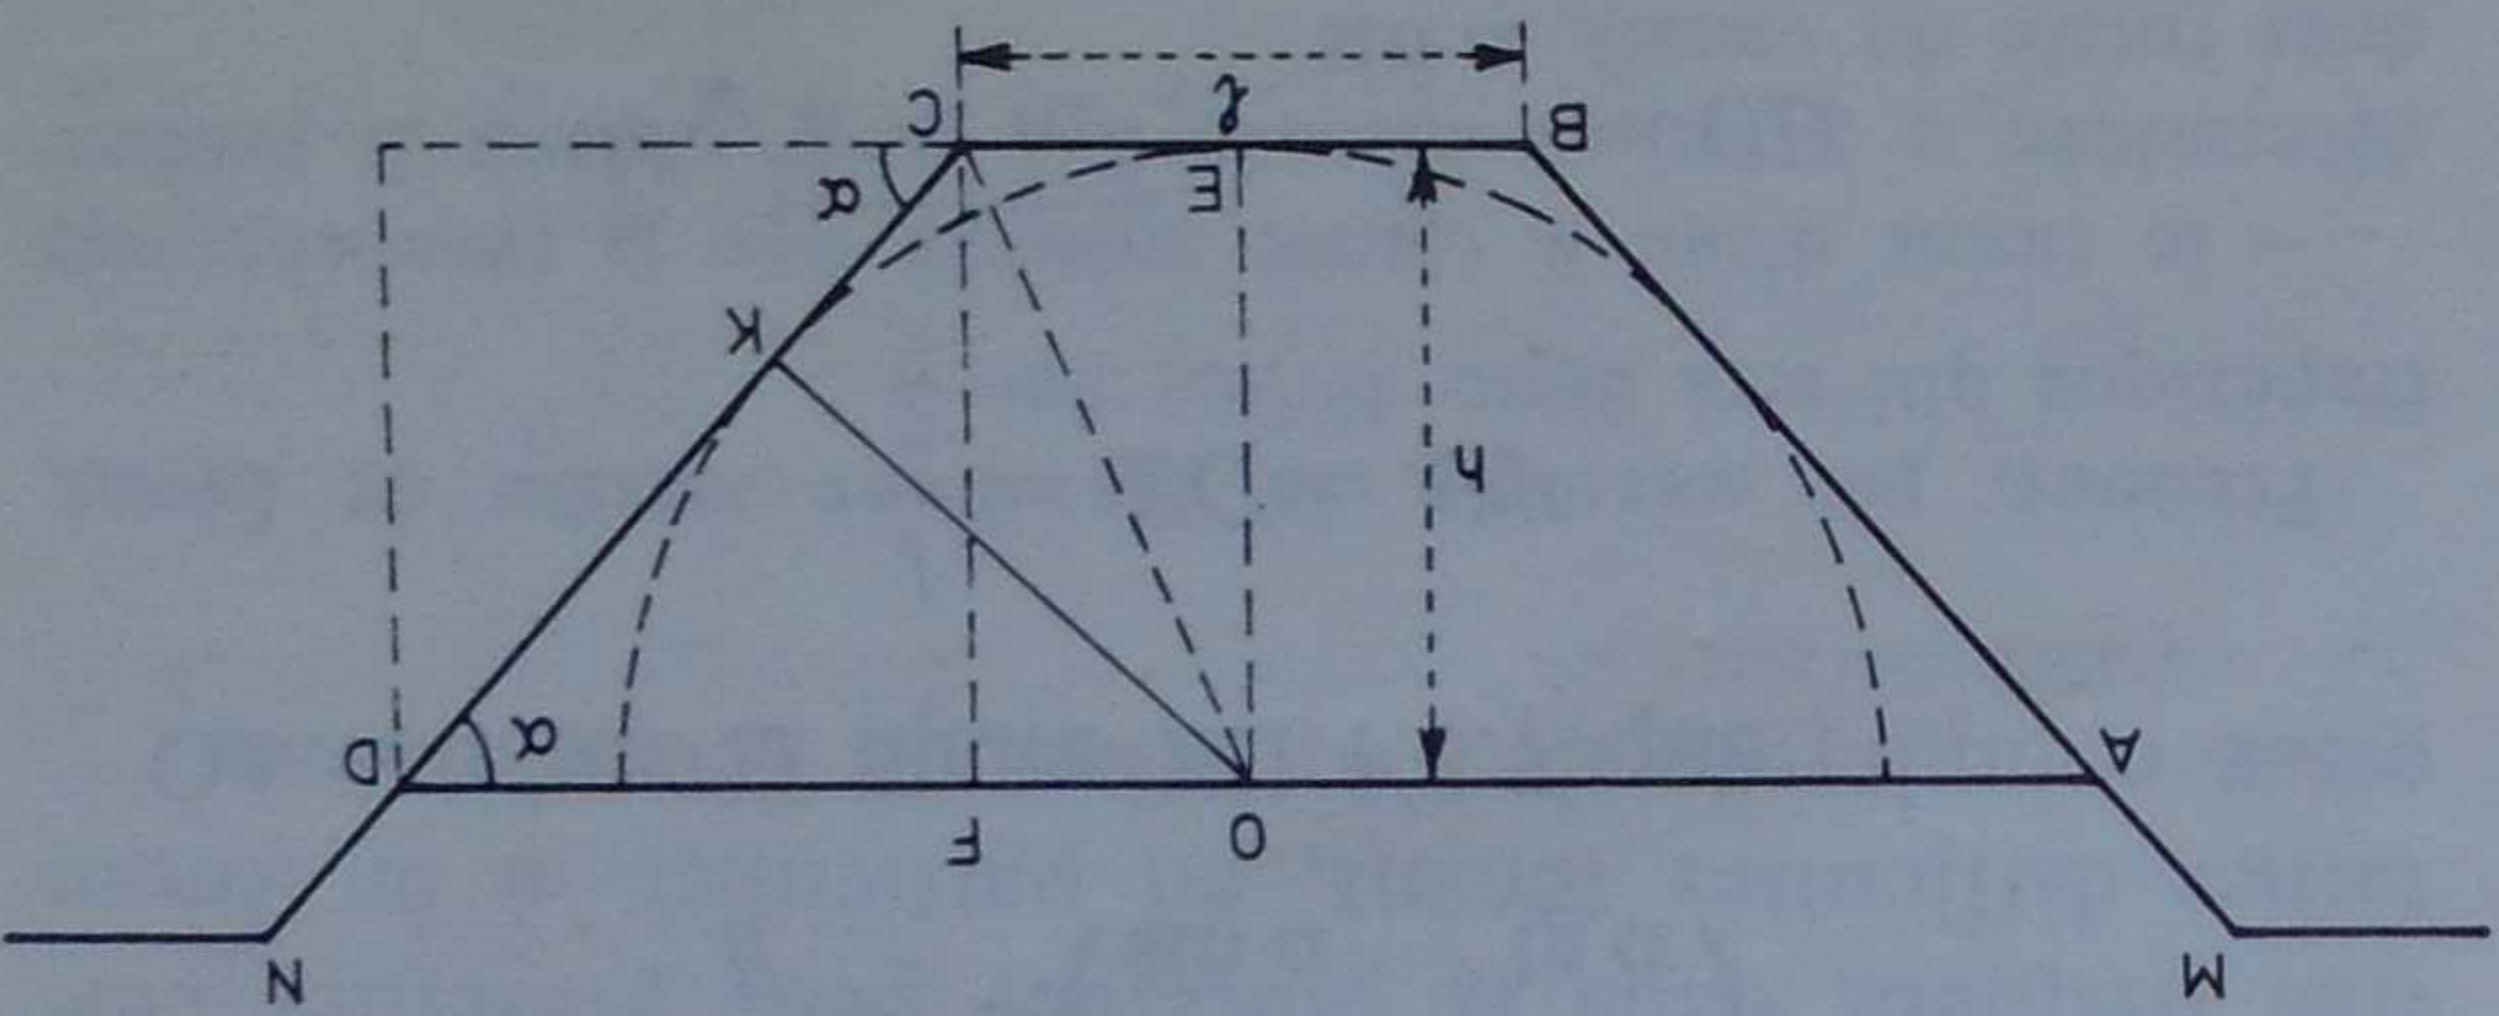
Section trapézoïdale de forme la plus avantageuse
